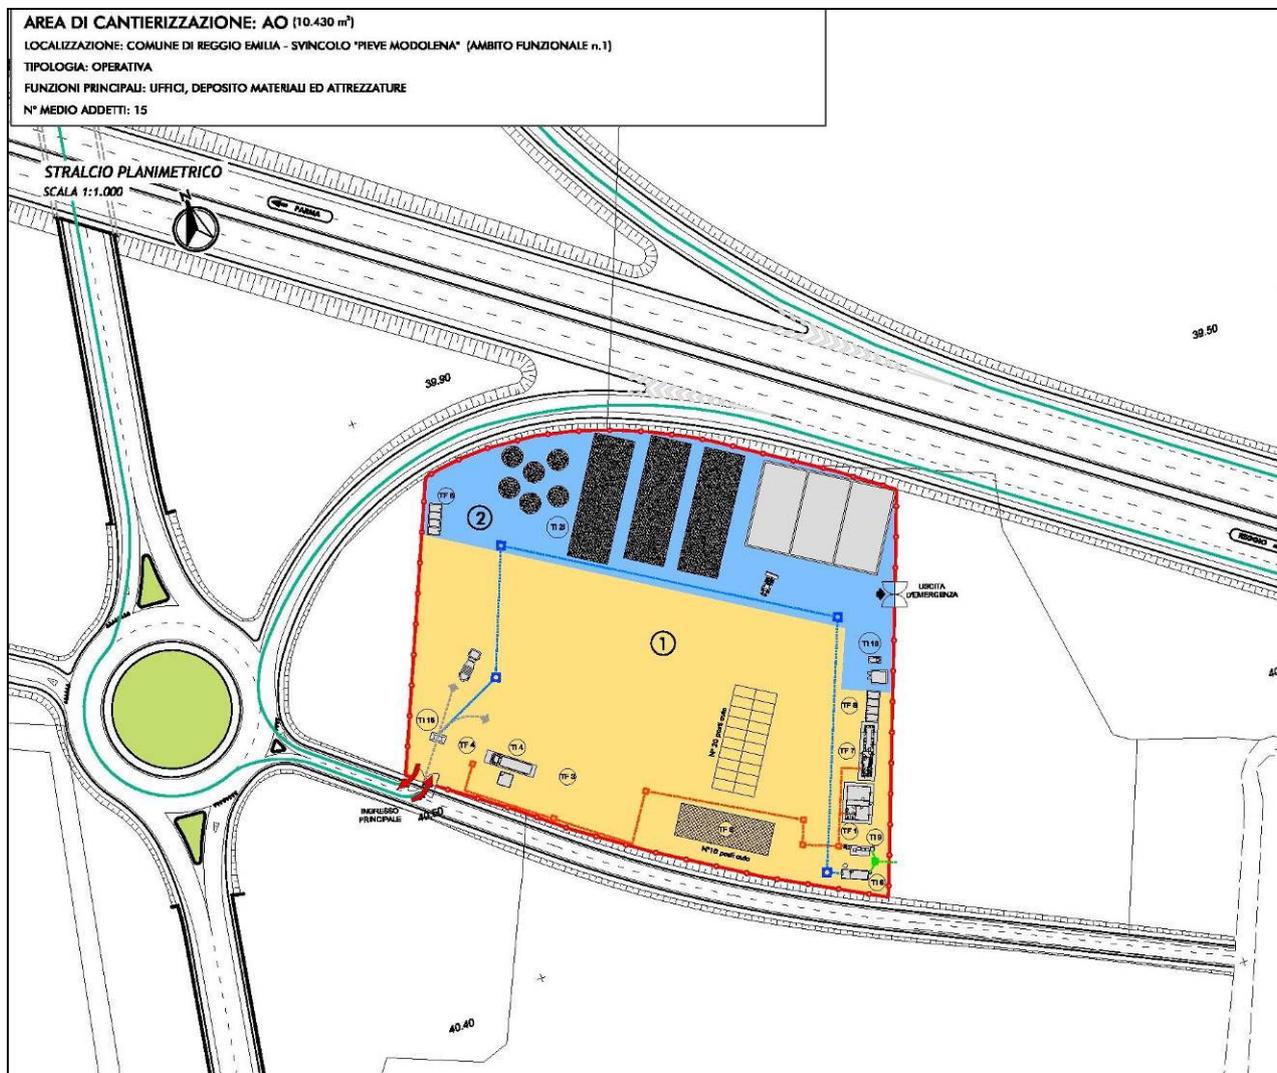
Layout aree di cantiere: area operativa Ambito 1 (stralcio planimetrico dell'elaborato T00IA24CANLF01A).
